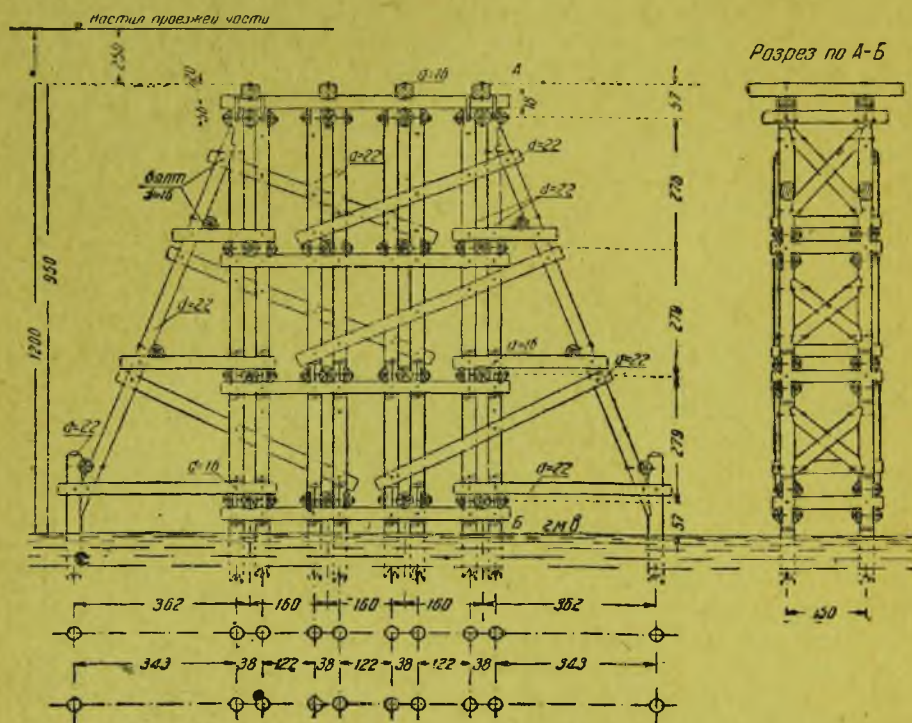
Схемы свайных опор для пролетных строений с решетчатыми фермами.
